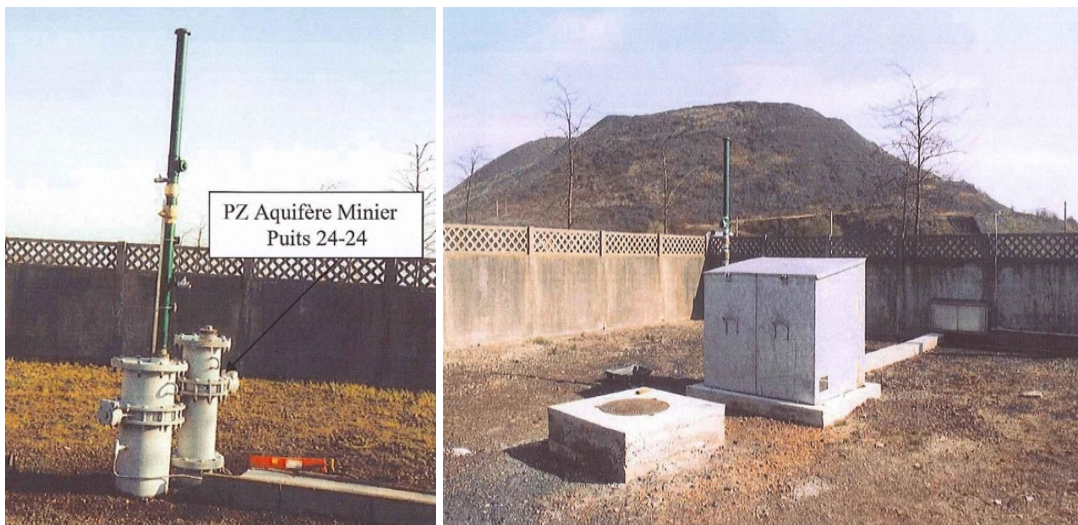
Installations techniques du puits 24 de Courrières (source BRGM)
